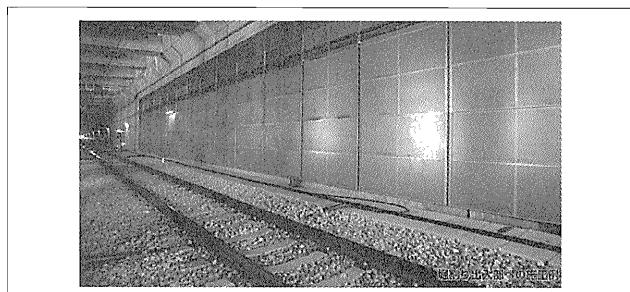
テプサム吸音壁「貼付けタイプ」のトンネル出入り部施工
